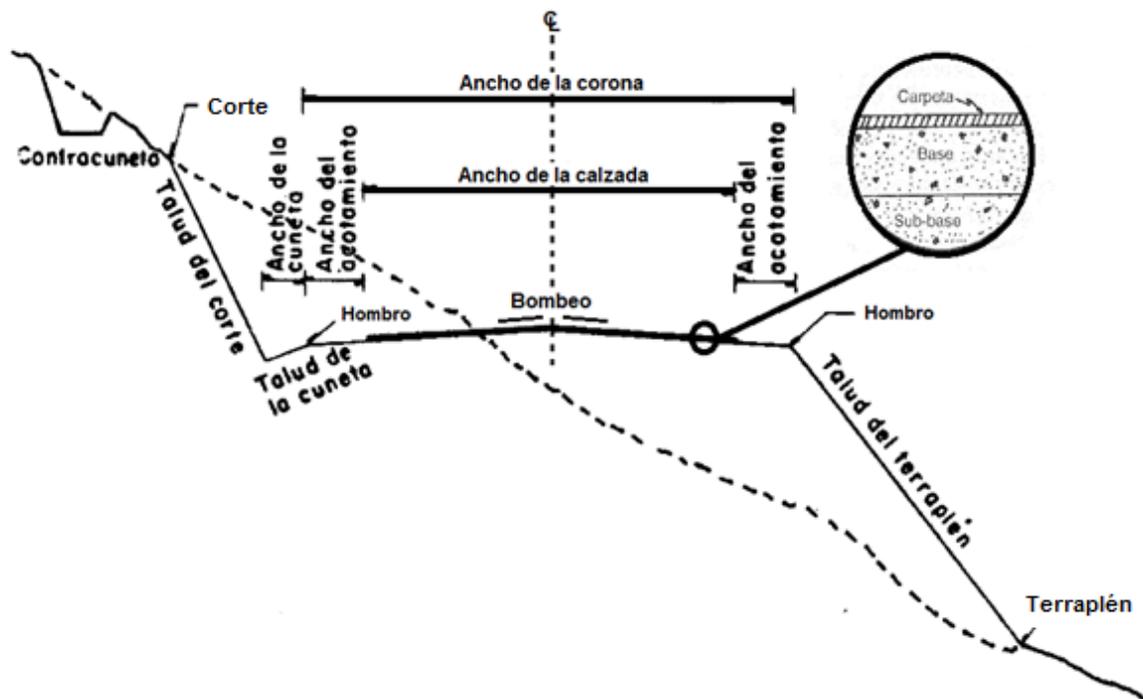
A. SECCIÓN TRANSVERSAL TÍPICA EN BALCÓN
